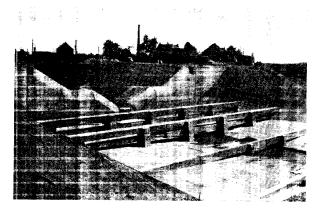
Mündungsbauwerk. Im Vordergrund Tosbecken mit Wasserbremsen.
